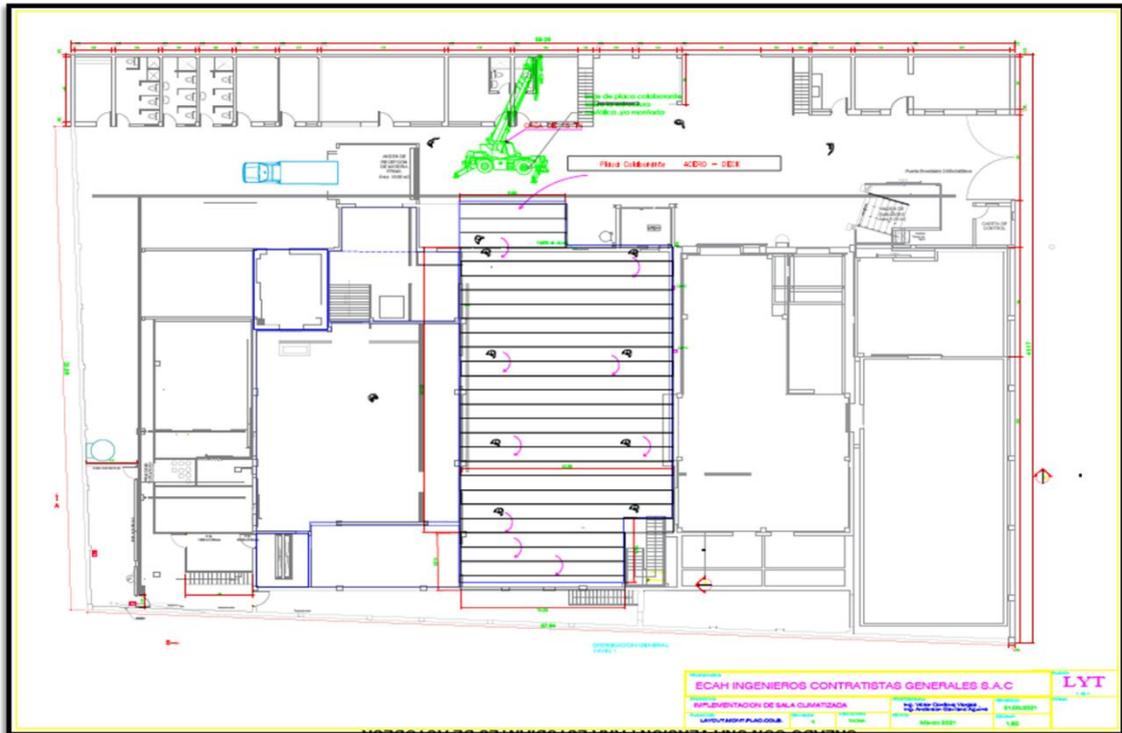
Layout de instalación de placa colaborante (1er nivel)
